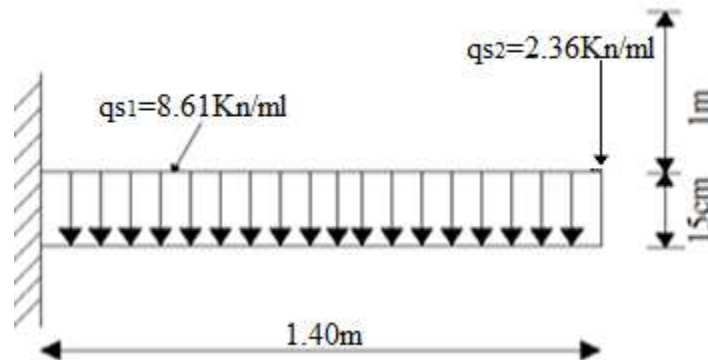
Schéma statique de la dalle plane à l'ELS.
